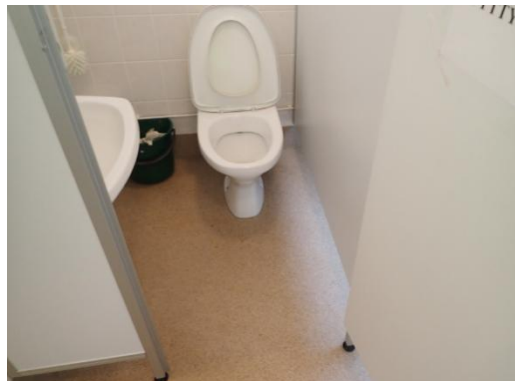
Wc-tilassa lattiassa akrylibetoni ja seinissä muovitapetti
